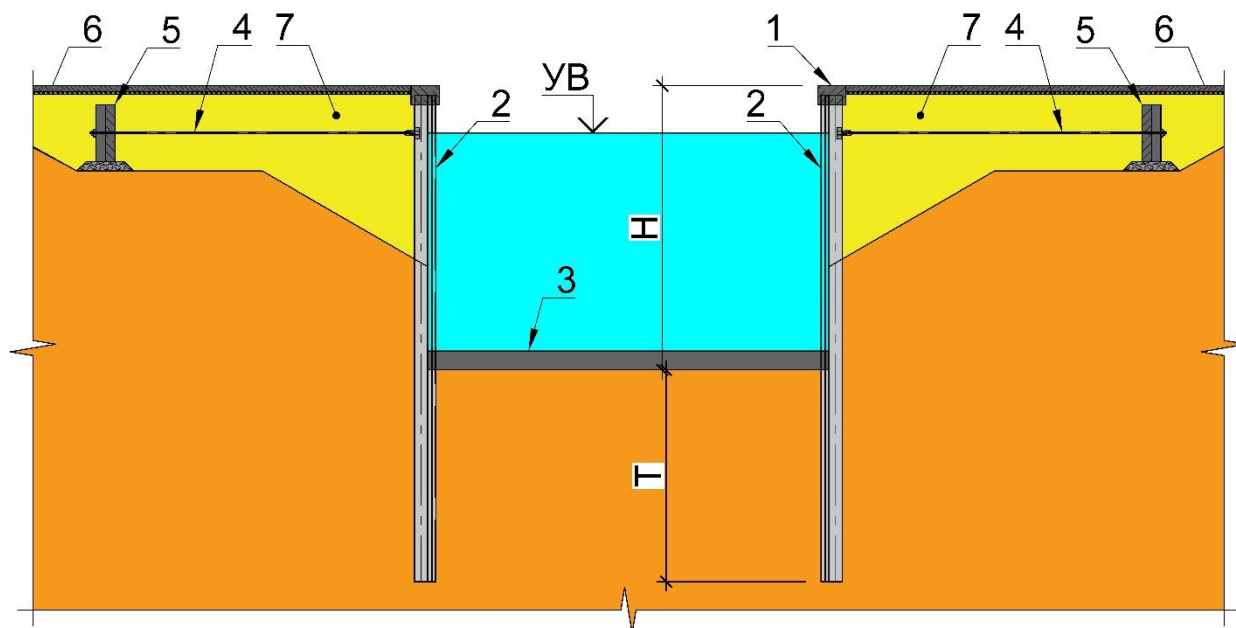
Схема камеры шлюза с водопроницаемым дном и стенами из БШС с анкерными плитами: H – высота стенки; T – глубина погружения шпунта; 1 – шапочный брус; 2 – БШС; 3 – распорная балка; 4 – анкерная тяга; 5 – анкерная плита; 6 – покрытие территории; 7 – засыпка.
